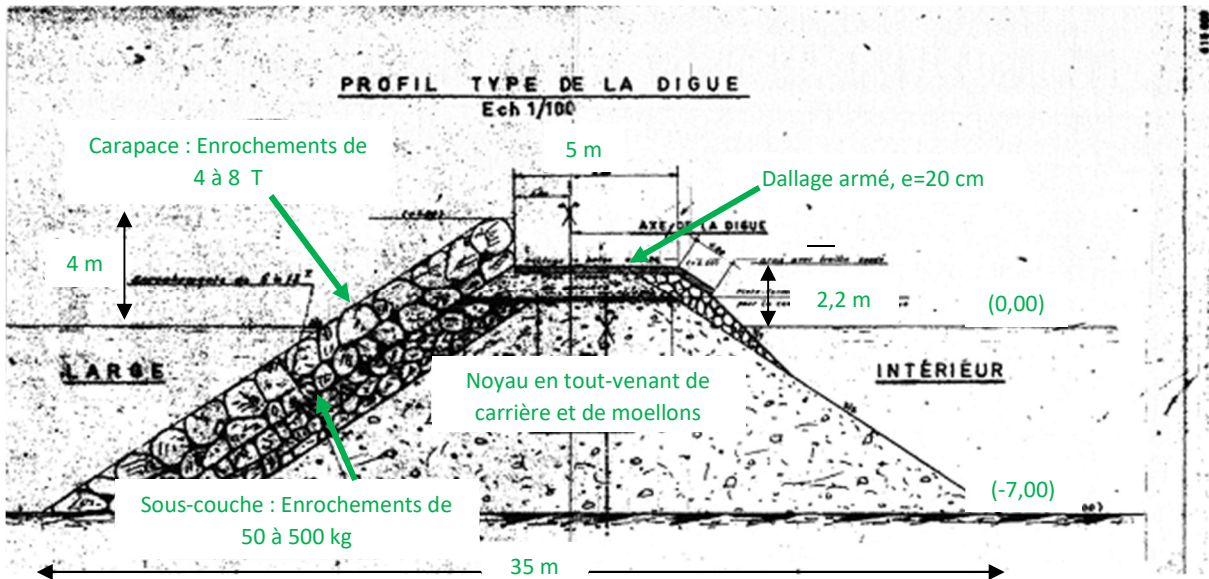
Coupe B-B (voir la position sur plan de masse en Figure 1).
